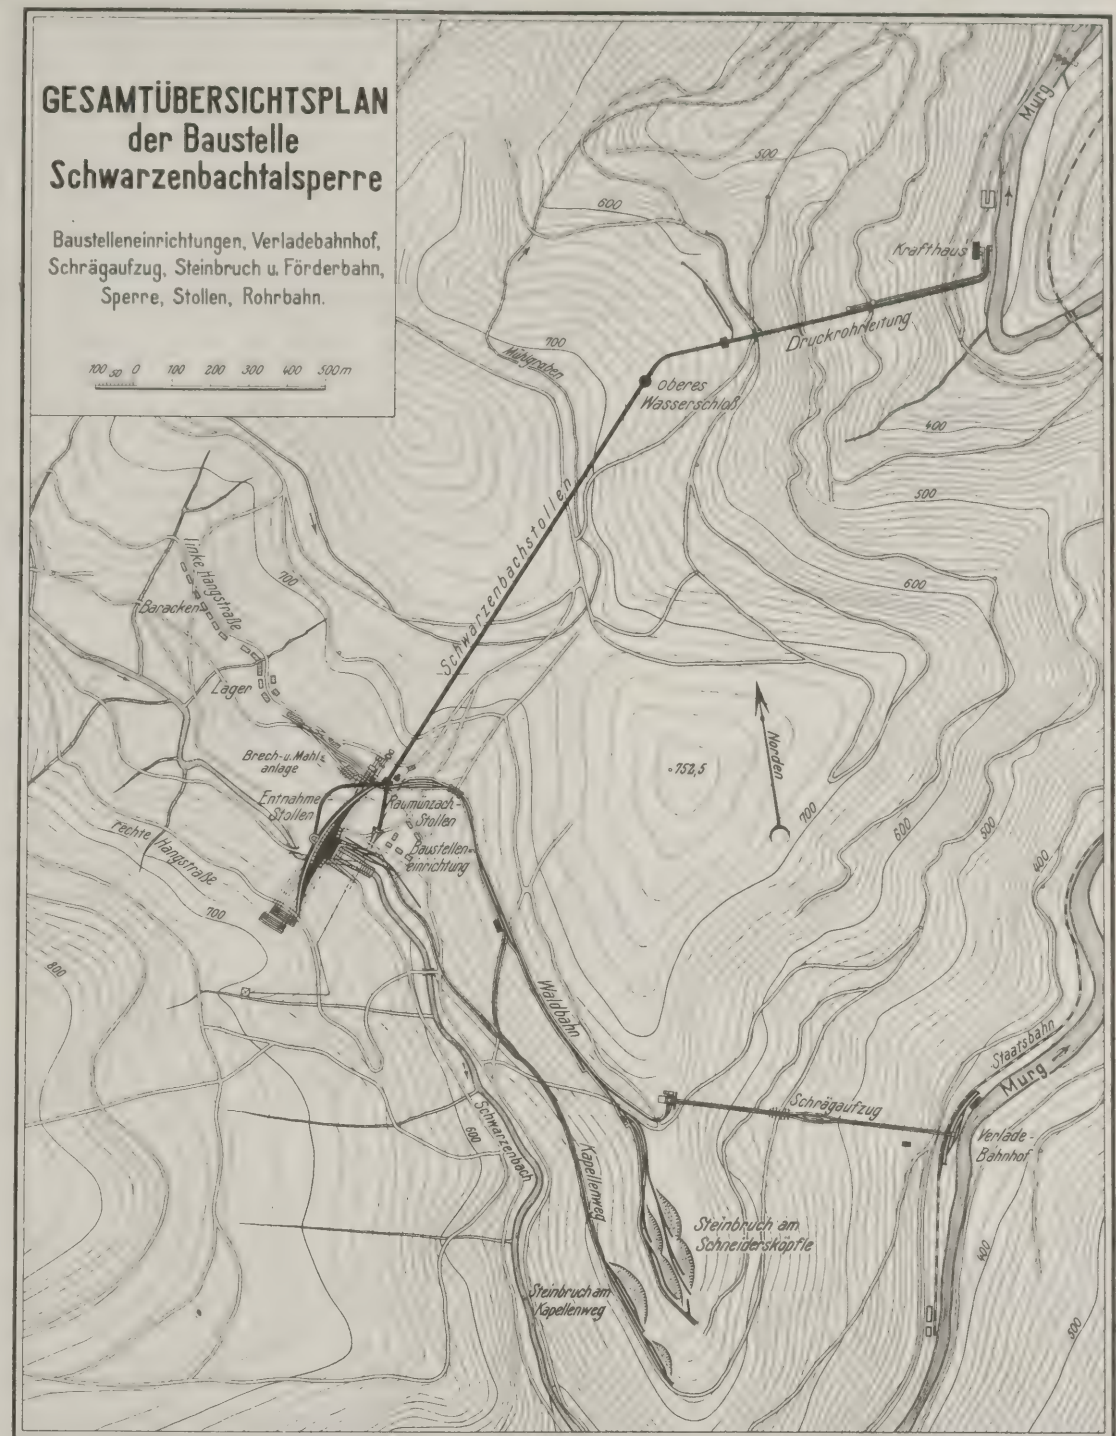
Lageplan für den zweiten Ausbau des Murgwerkes.
